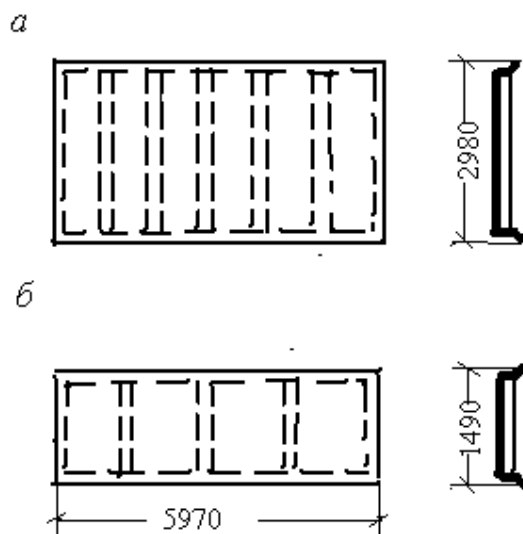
Железобетонные ребристые плиты пролетом 6 м:
